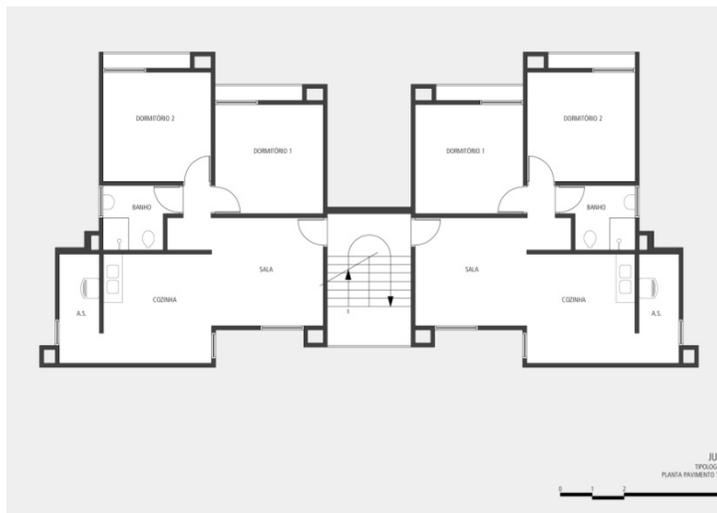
Tipologia planta baixa tipo B, Conjunto da União da Juta
